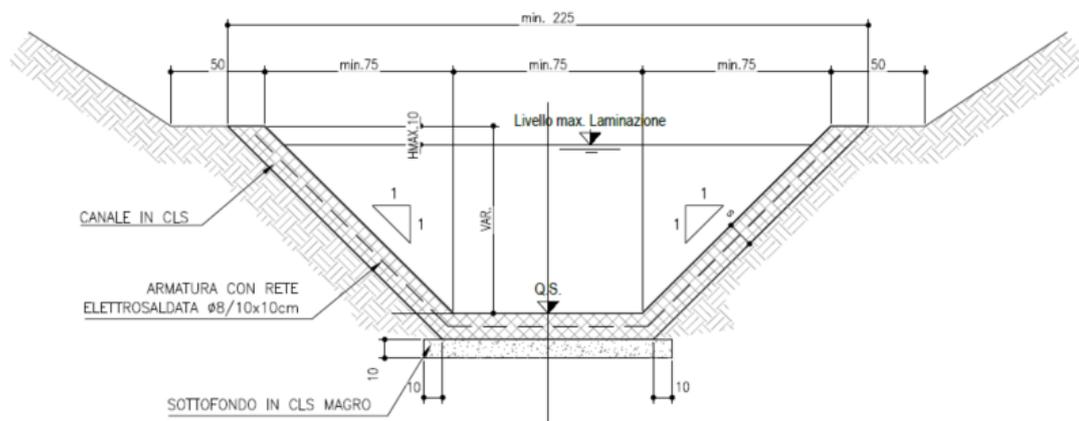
Sezione tipologica dei fossi di laminazione a sezione trapezia.
